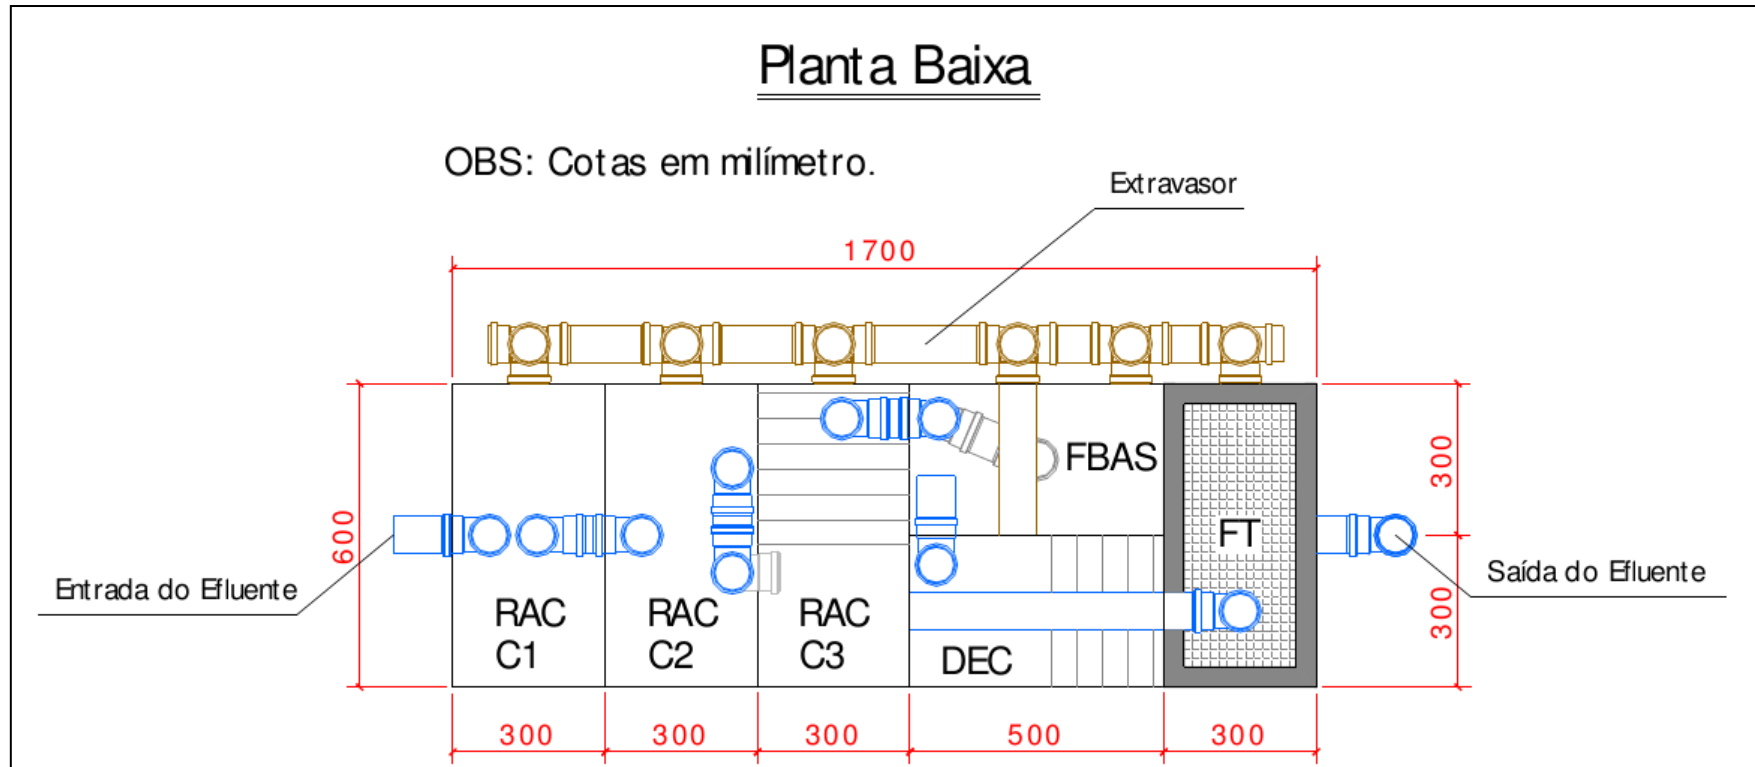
Planta baixa – ETAC utilizada para o filtro anaeróbico.
